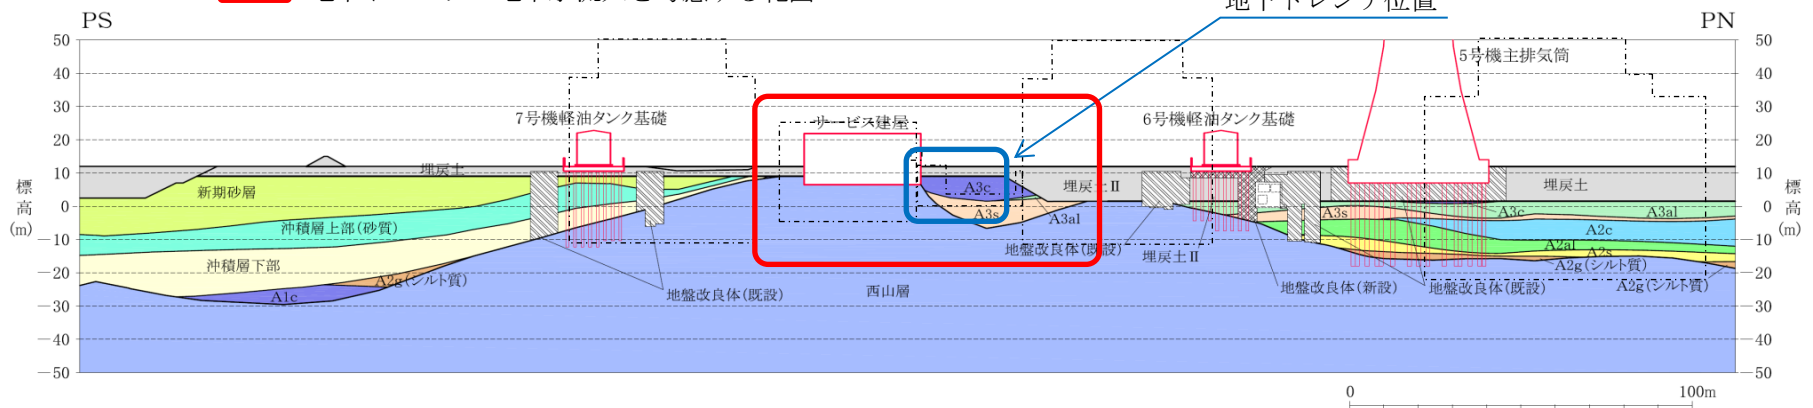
汀線平行 地質断面図(軽油タンク基礎中央)(B-B断面)
